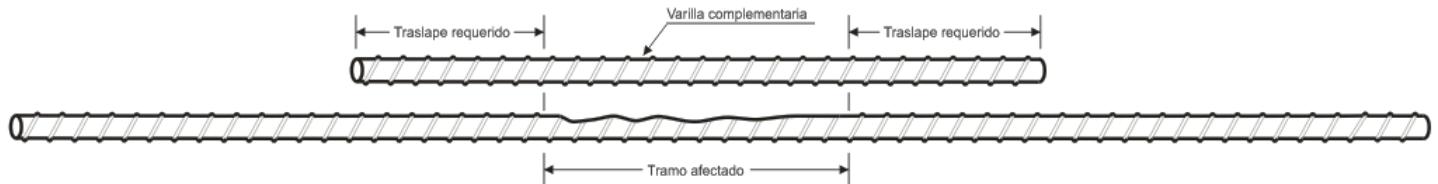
Si se requiere reparaciones para el acero de refuerzo se puede reemplazar completamente la varilla o colocar una varilla complementaria sobre la sección afectada.
